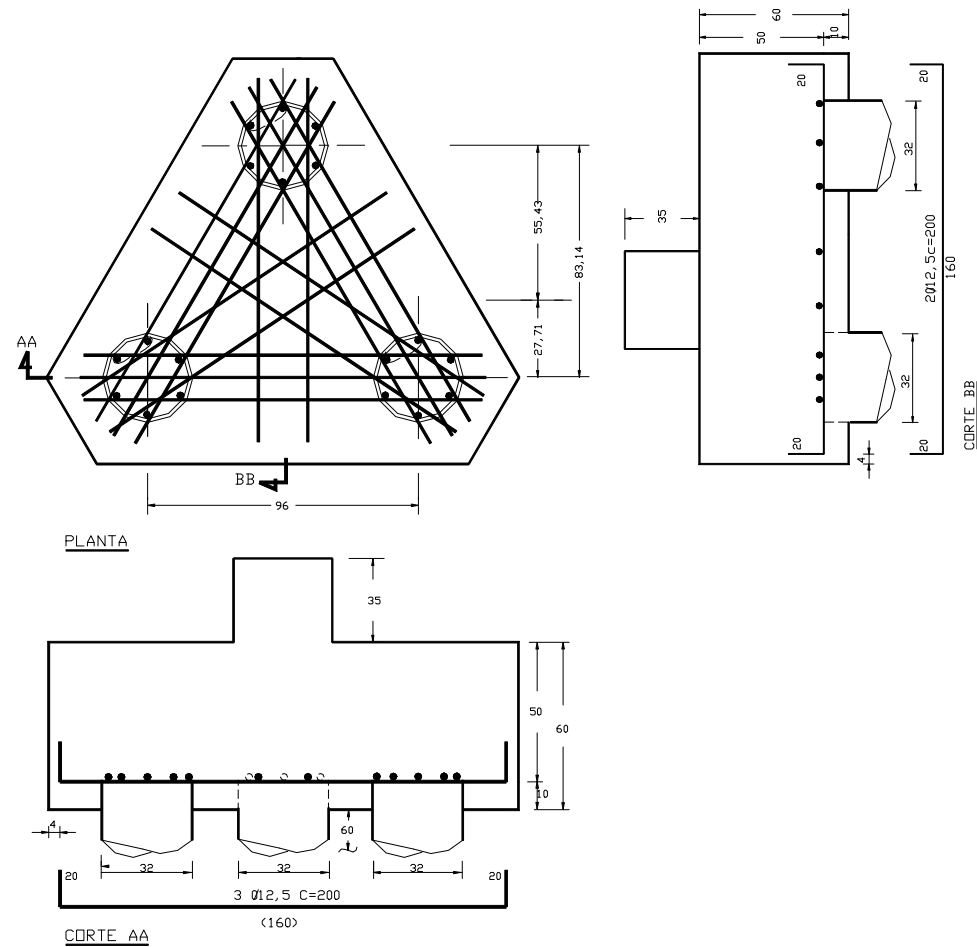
Armadura principal e armadura passando pelo pilar (D = 30 cm)
